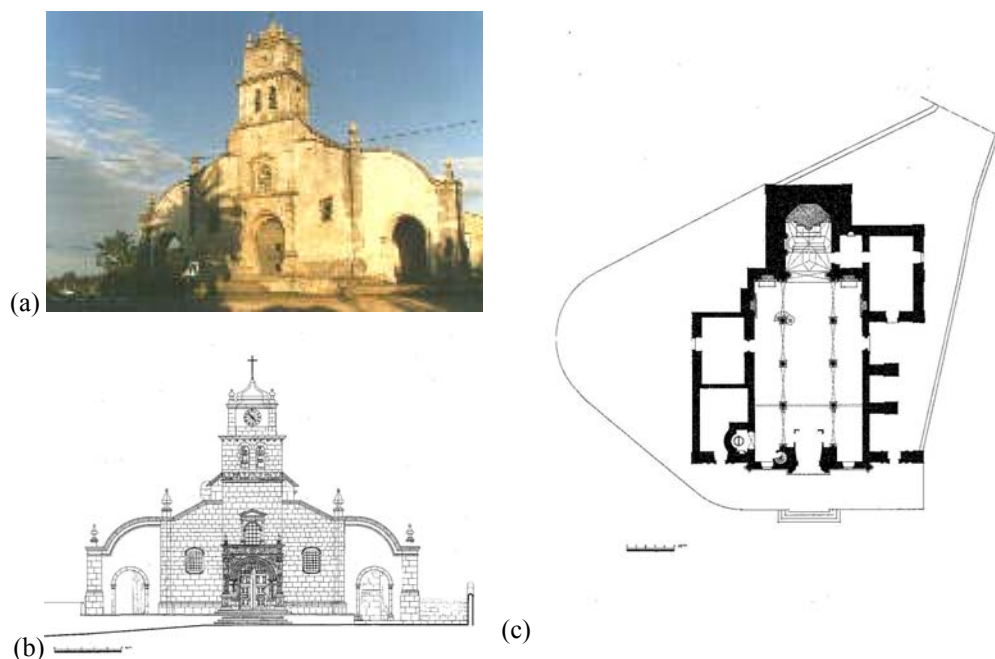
Peças desenhadas [Fonte: DGEMN]: (a) fotografia; (b) alçado frontal; (c) planta.
